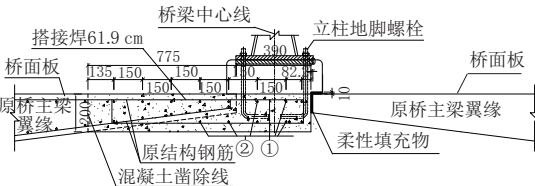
中翼缘混凝土刚接拓宽标准断面布置(单位:cm)
